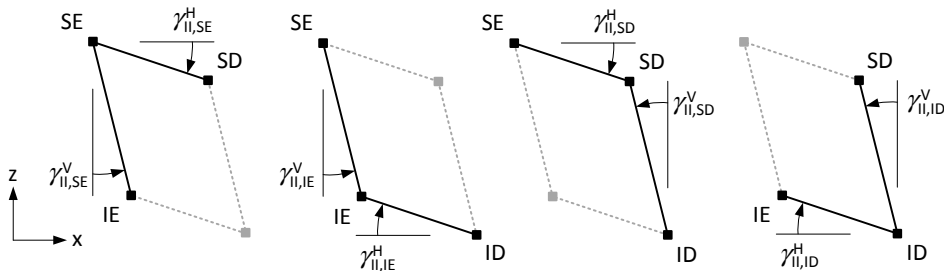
Determinação da distorção da ligação viga-pilar (segunda abordagem).
